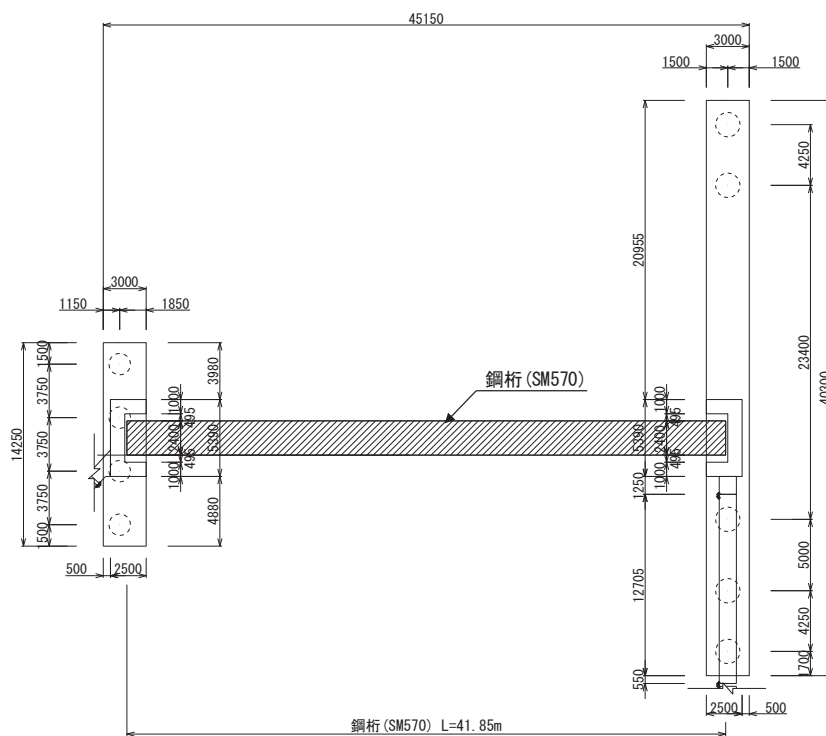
(2) 鋼製遮水壁（鋼桁 1） 平面図
